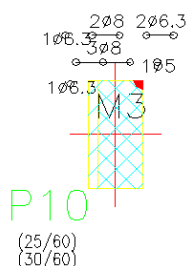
Armadura proposta pelo programa para a punção em um pilar.
